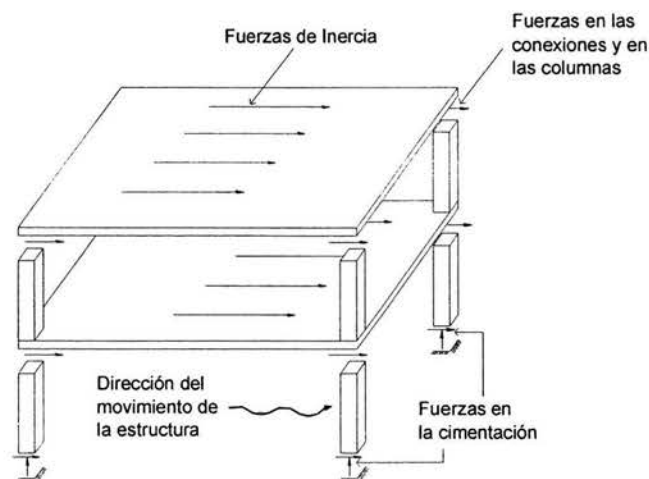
Flujo de fuerzas en la figura debido a la vibración
